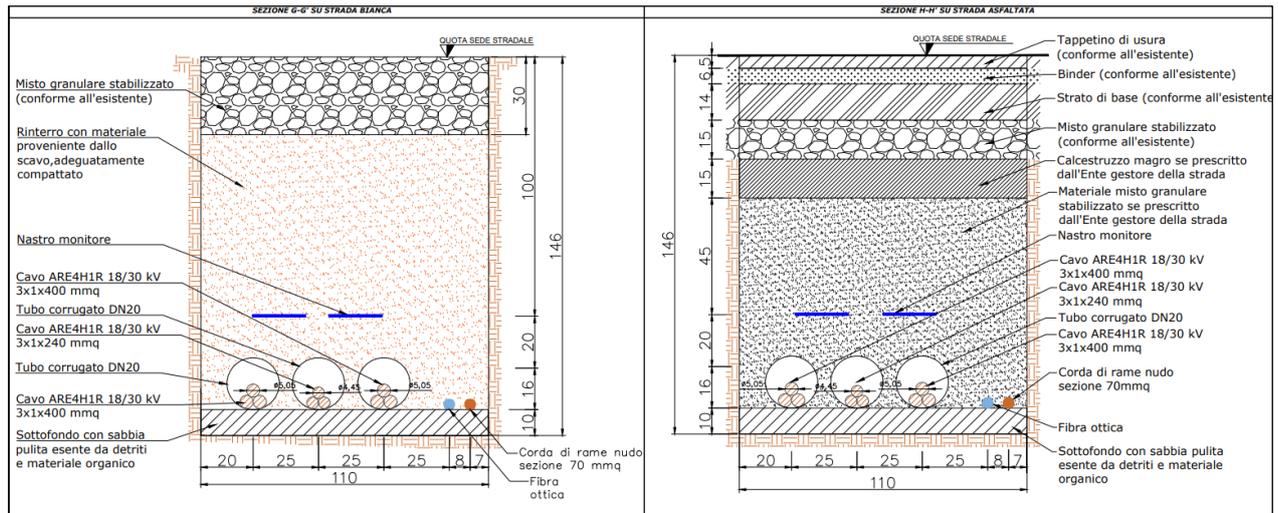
Sezione cavidotto MT composto da tre terne di cavi a 30 kV su strada asfaltata e su strada bianca.
